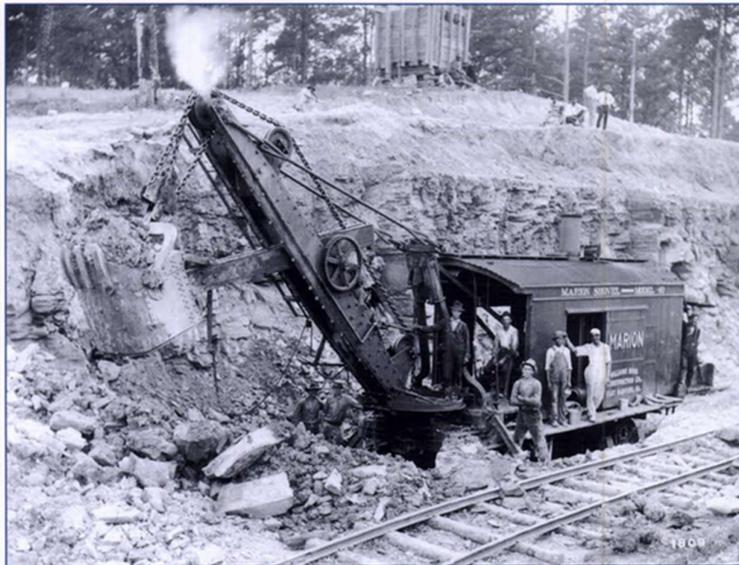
Escavadeira Marion Model 40, inaugurada em 1908.
